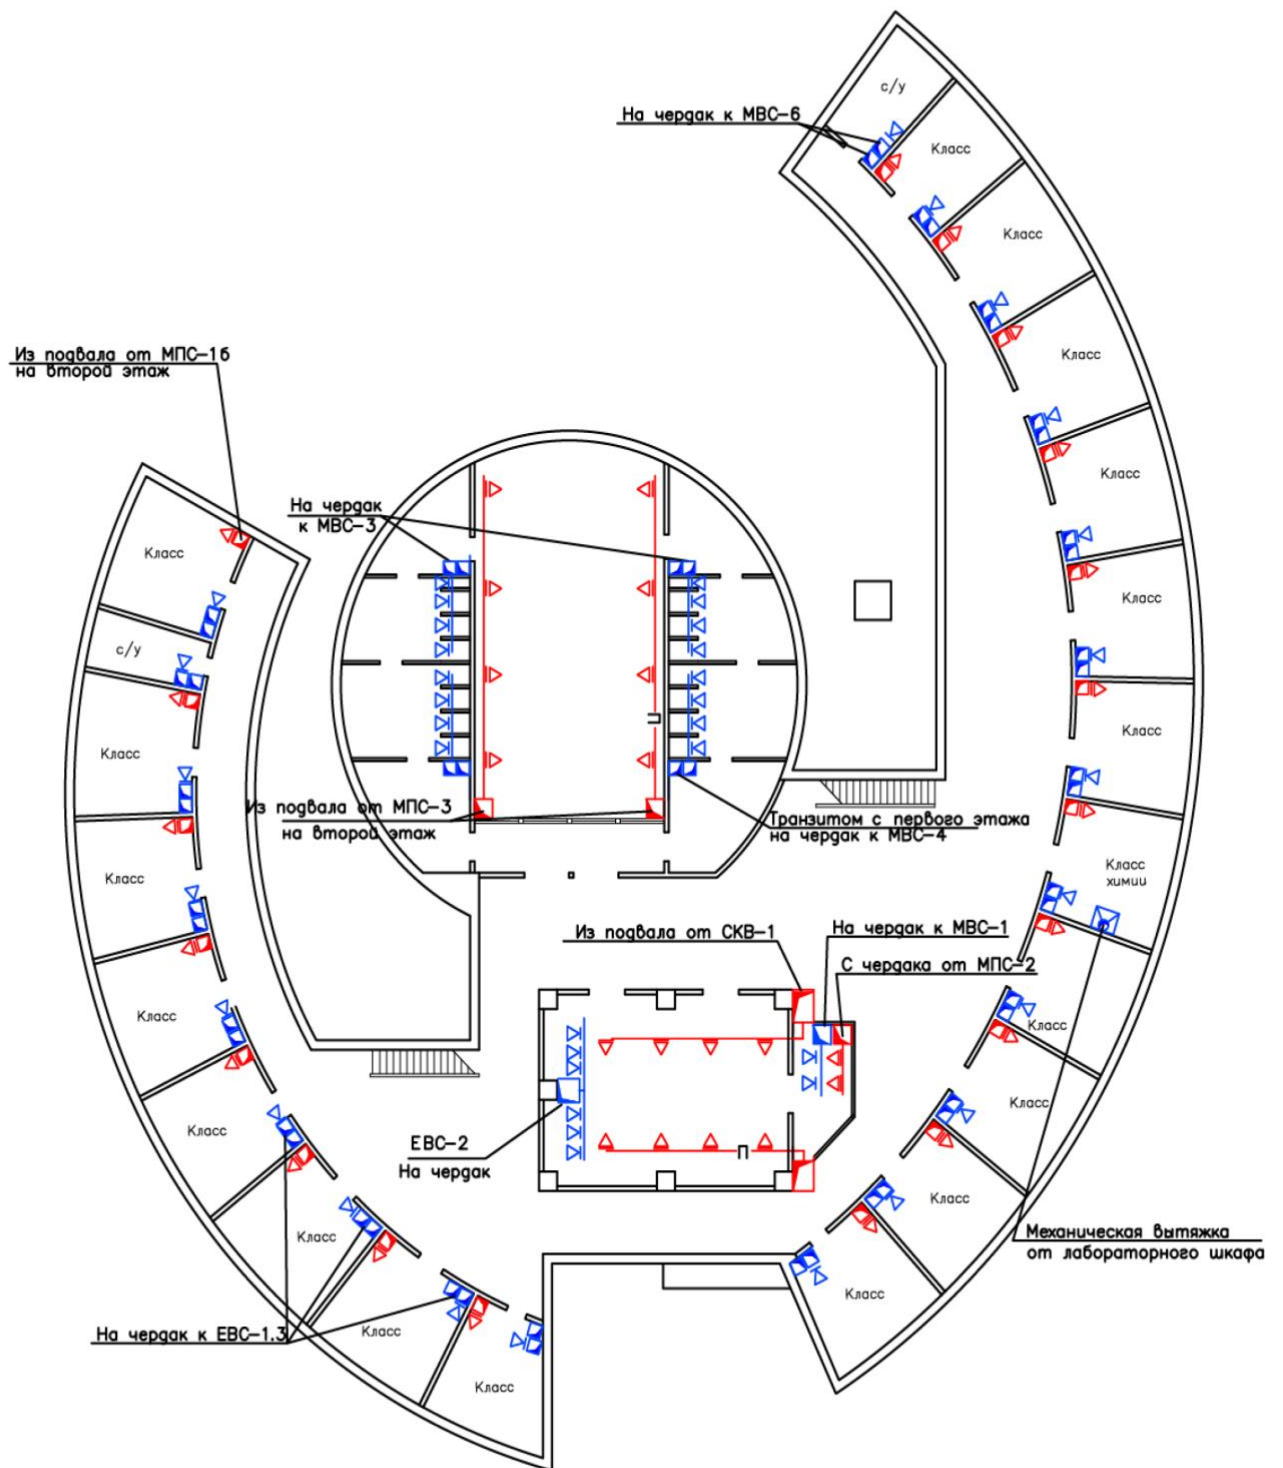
Рисунок IV Пример размещения оборудования, воздухозаборных устройств и воздуховодов систем вентиляции и кондиционирования на первом этаже здания школы
